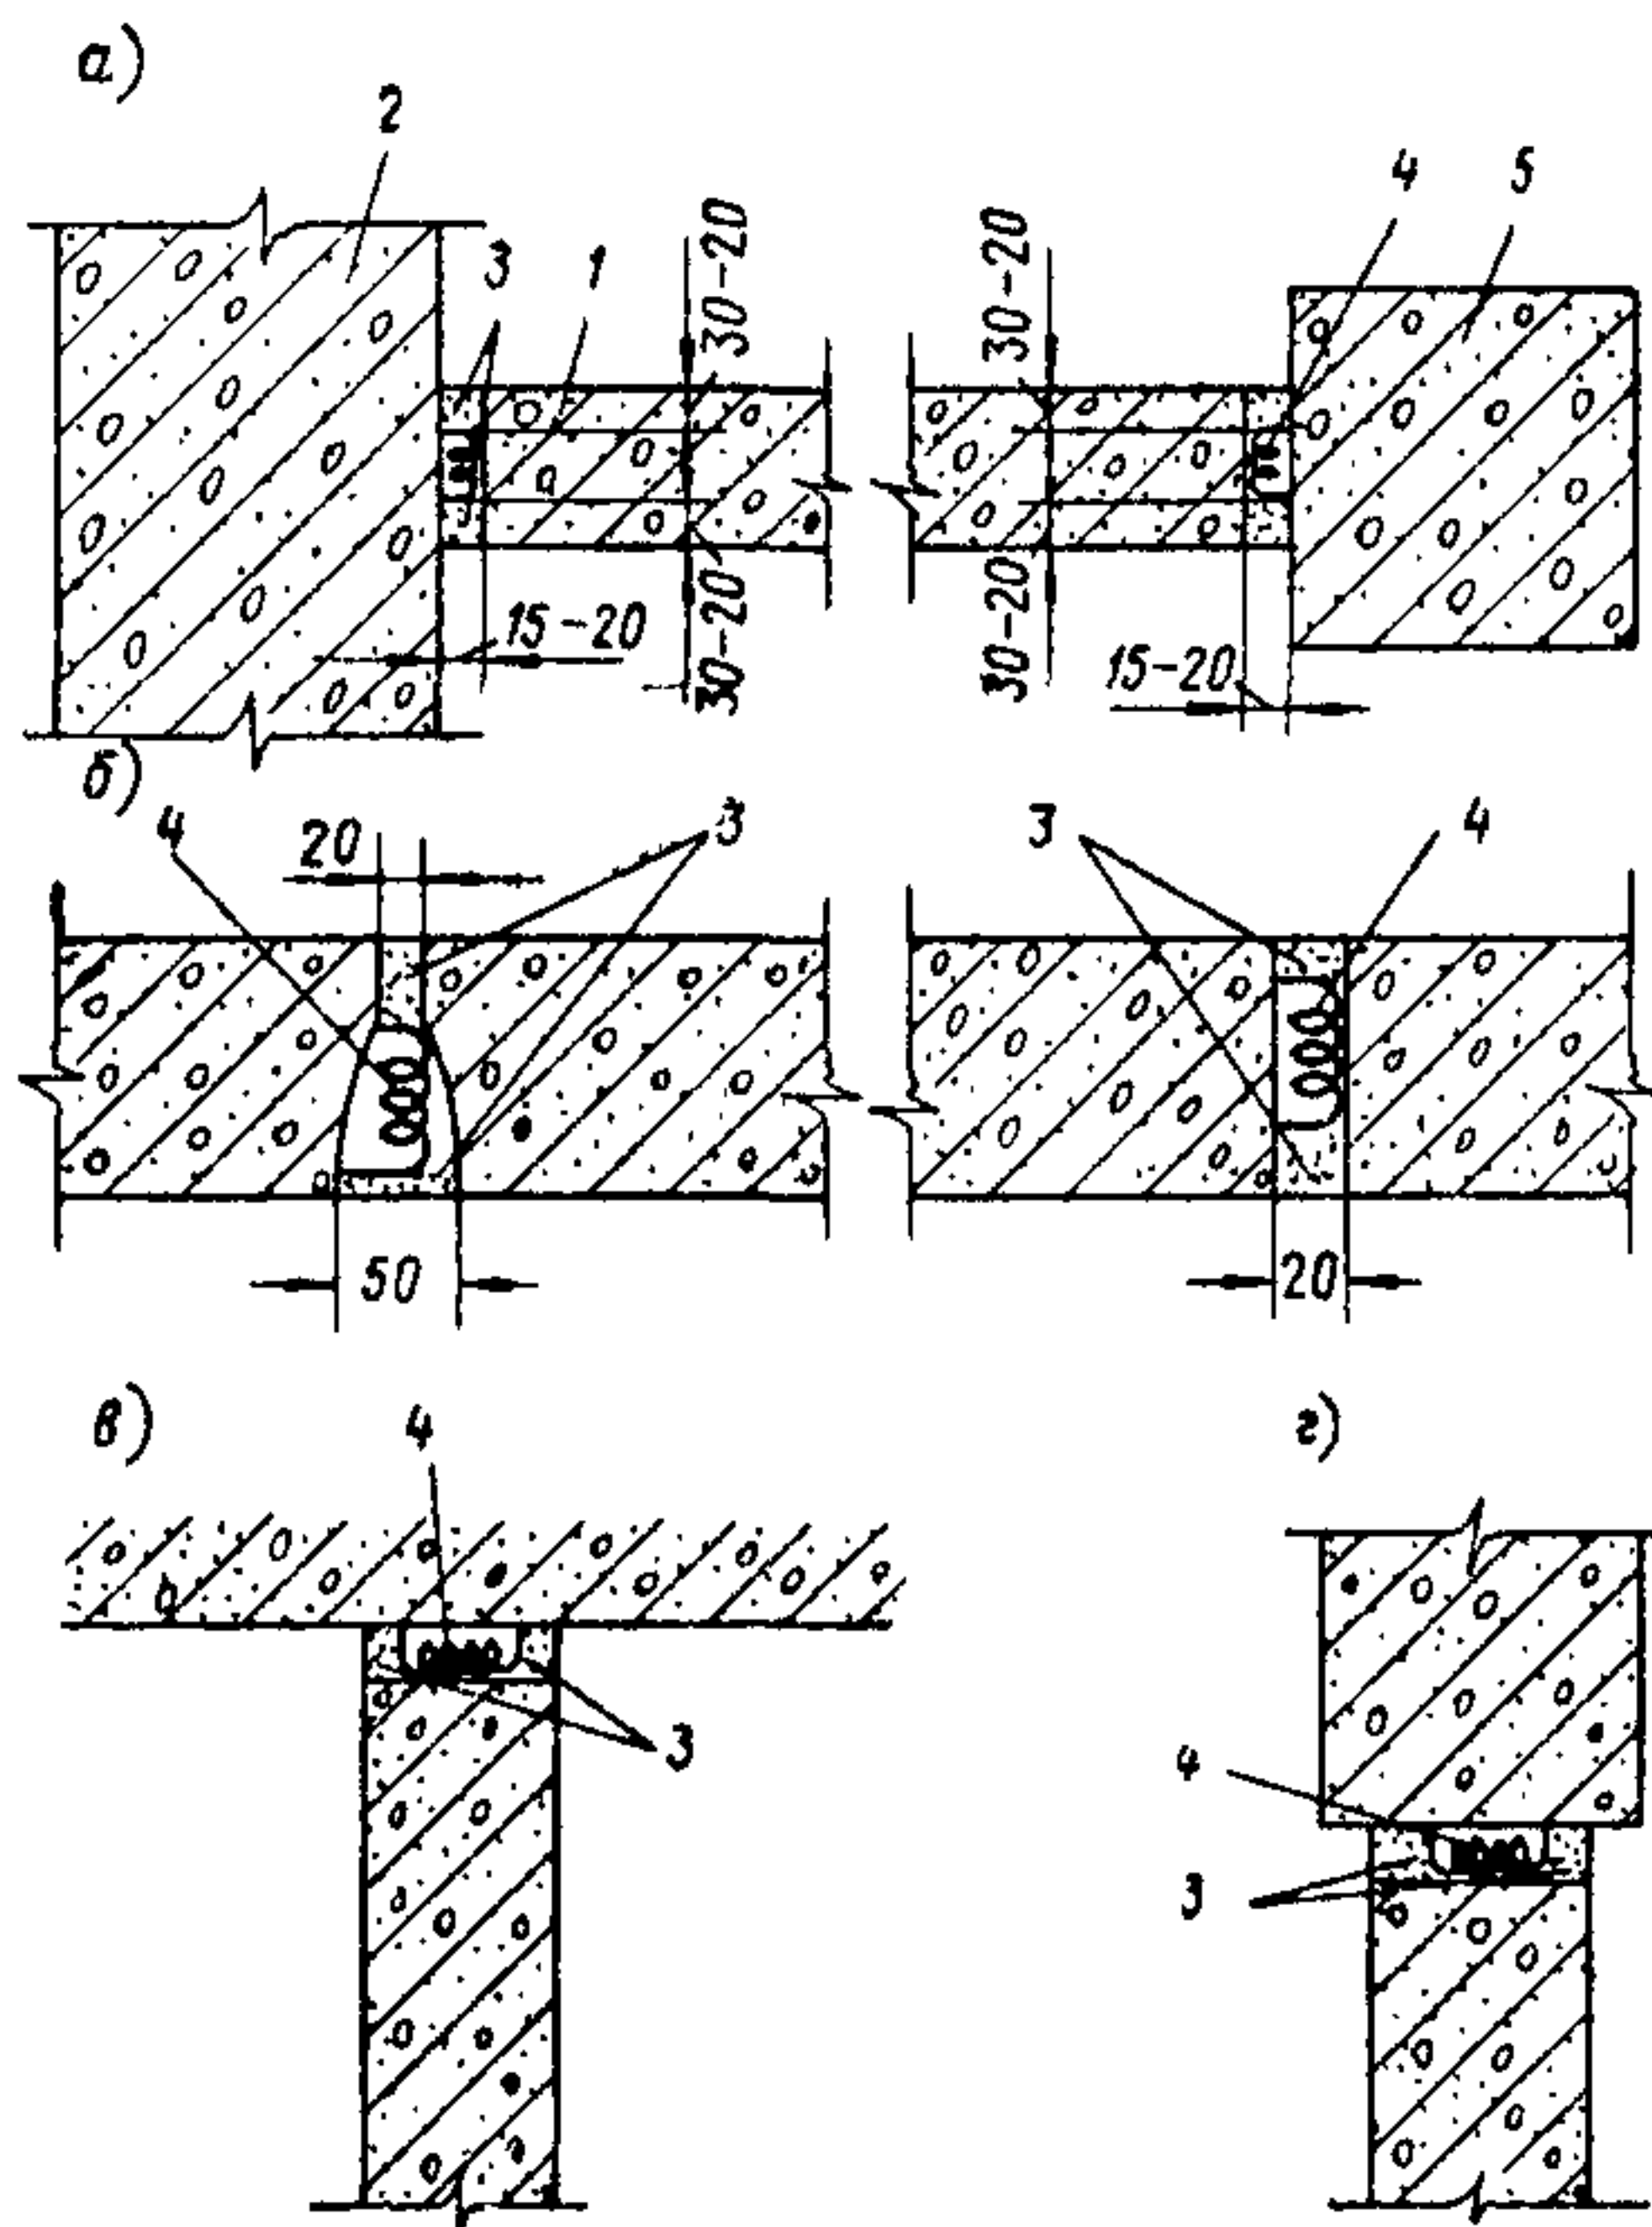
Схема сопряжений перегородок с другими конструкциями
